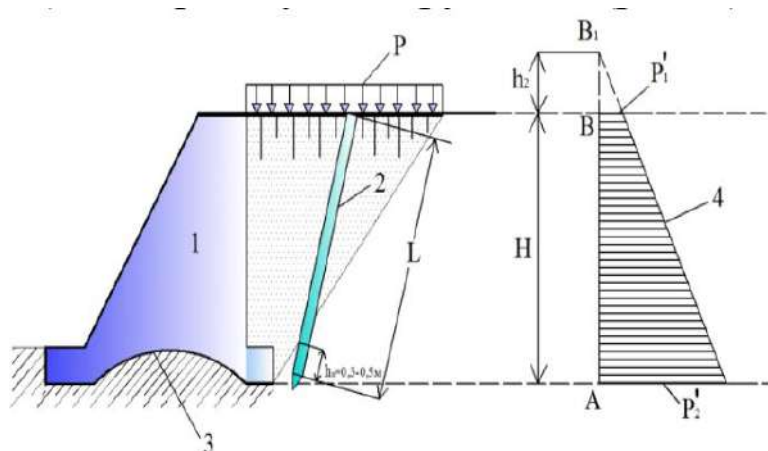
Укрепление насыпной части земляного полотна береговой опоры моста сваями
